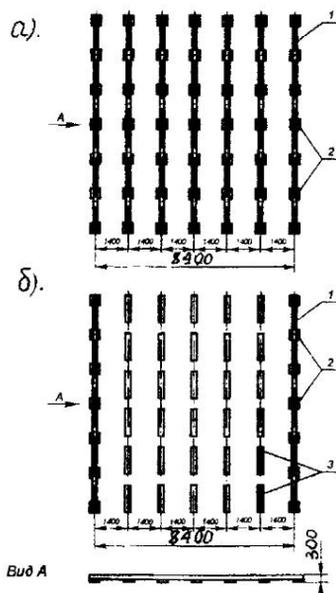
Схема подштабельных фундаментов для укладки пакетных штабелей краном в закрытом неотапливаемом складе (а) и автопогрузчиком под навесом (б):
